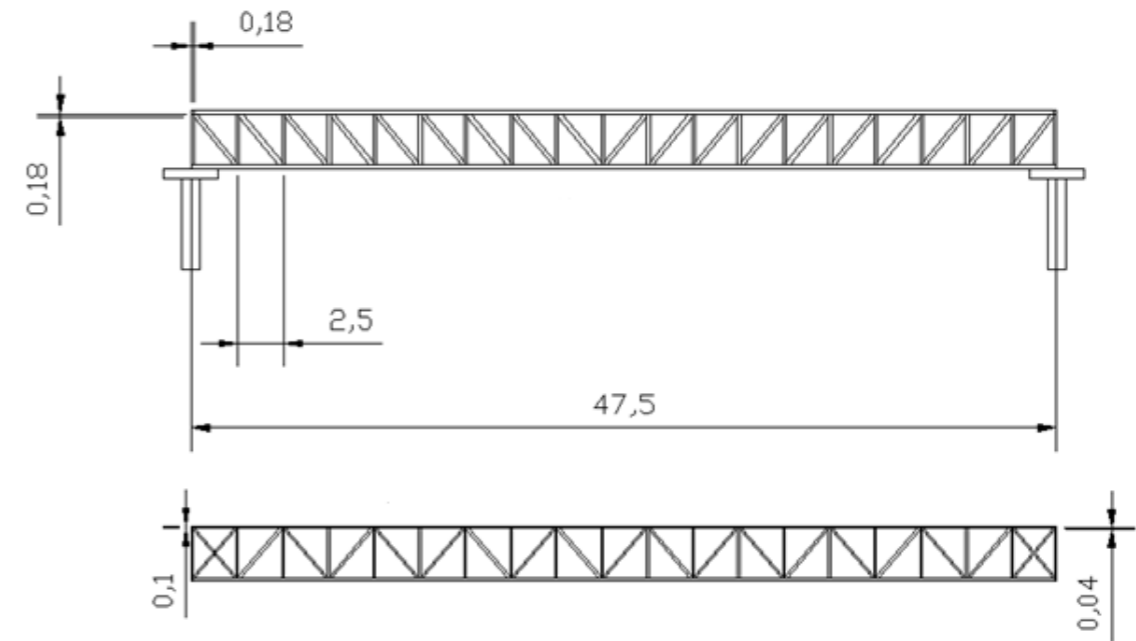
Alzado y planta pasarela peatonal tipo Pratt.
